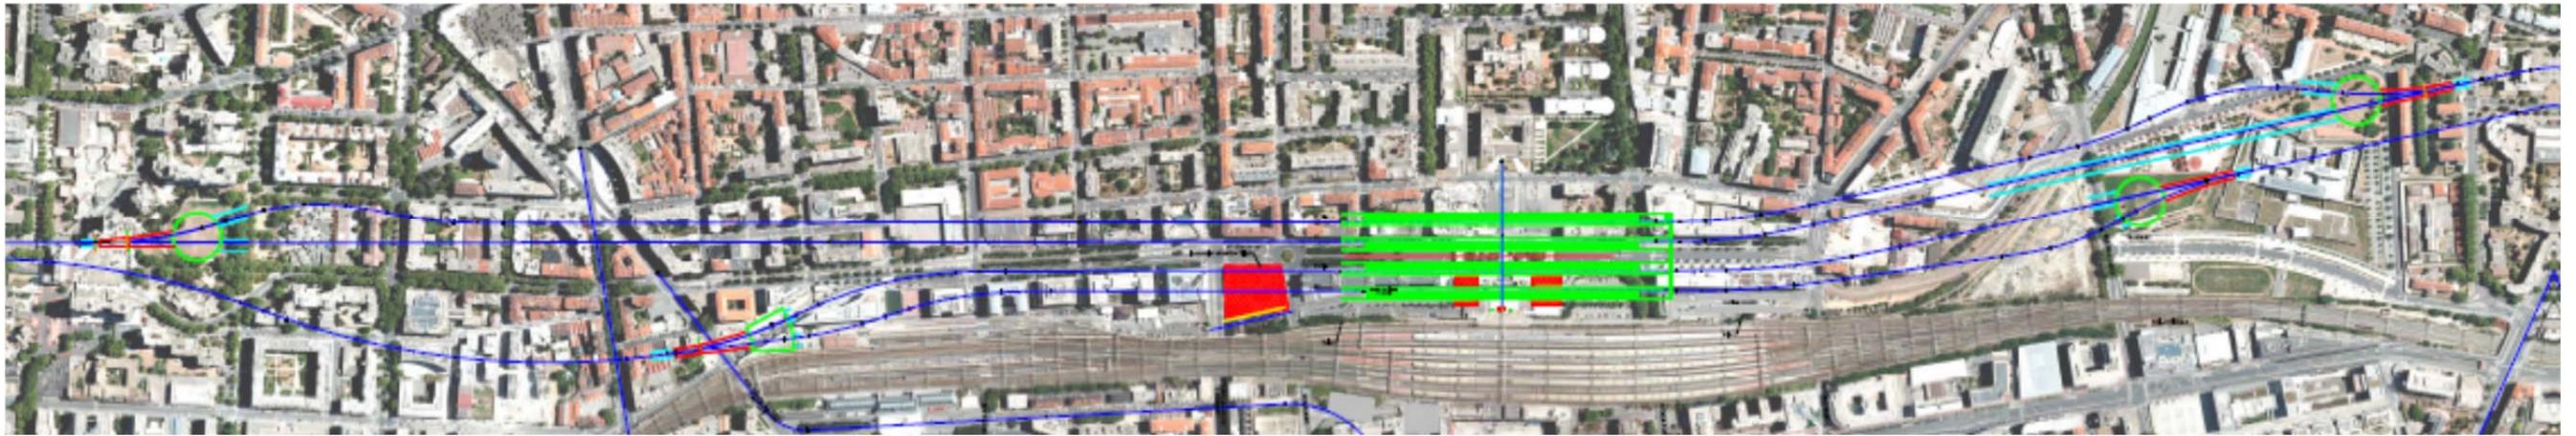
Vue en plan générale de la solution 4 TBM étudiée
